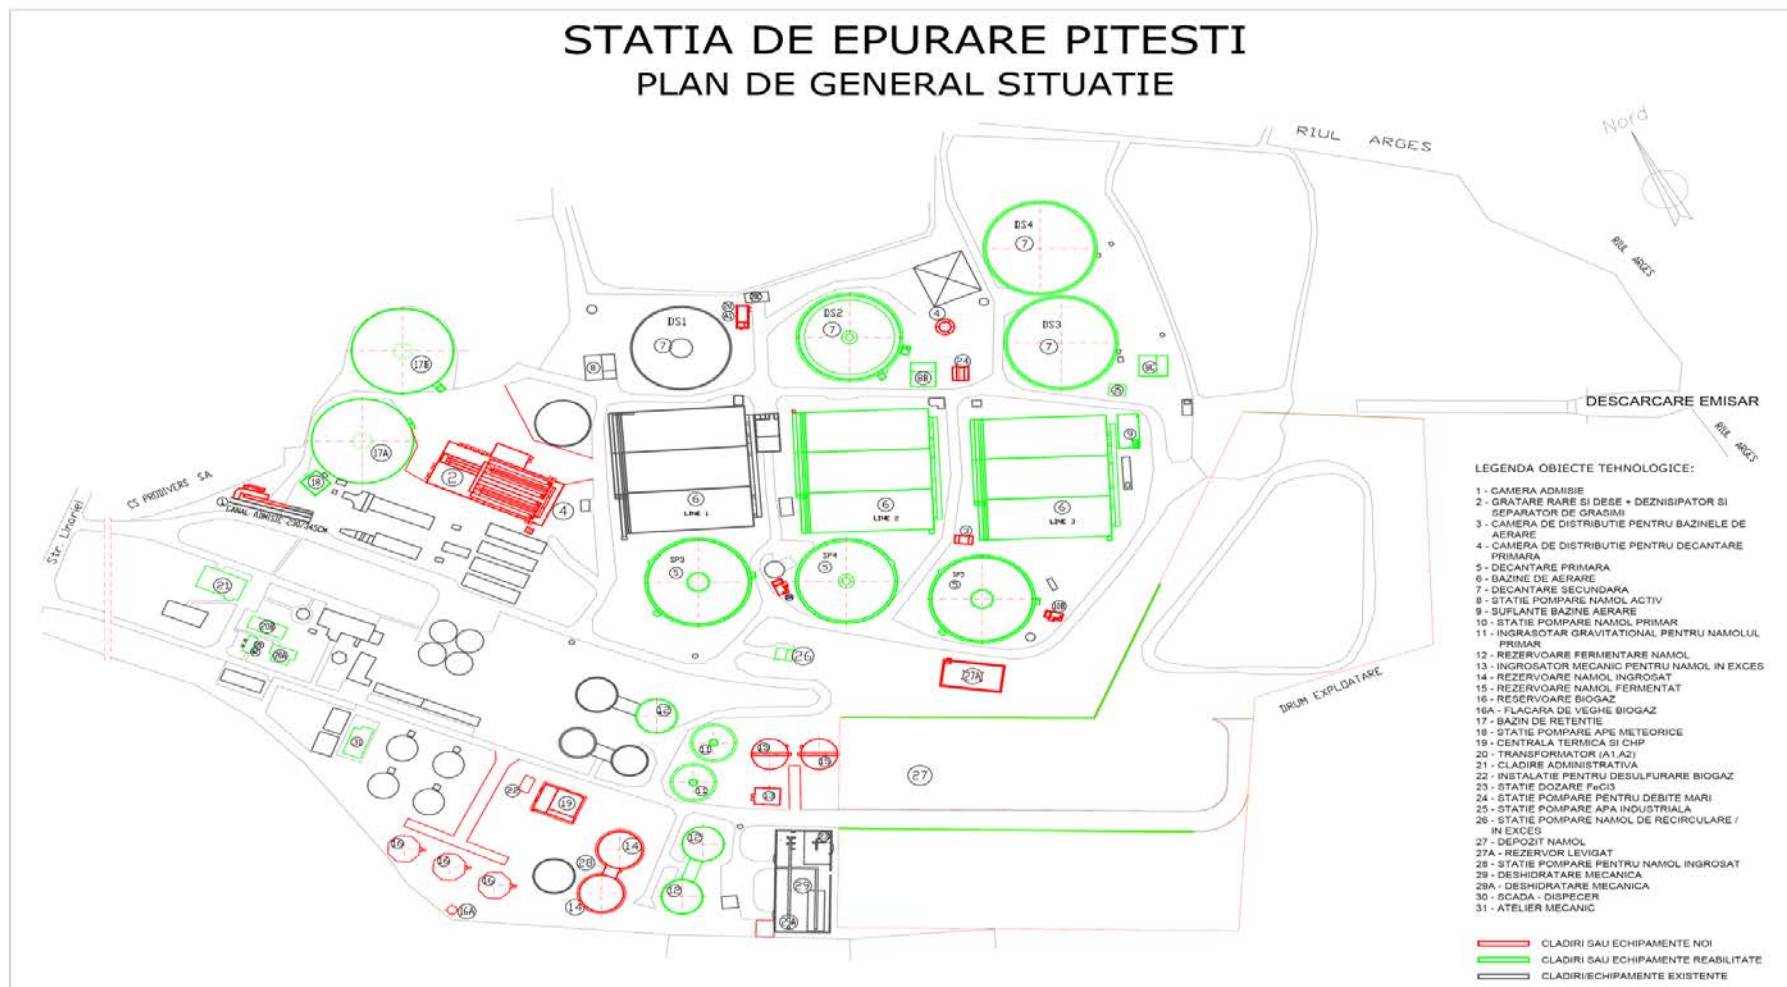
Stația de epurare Pitești – Plan de situație general
